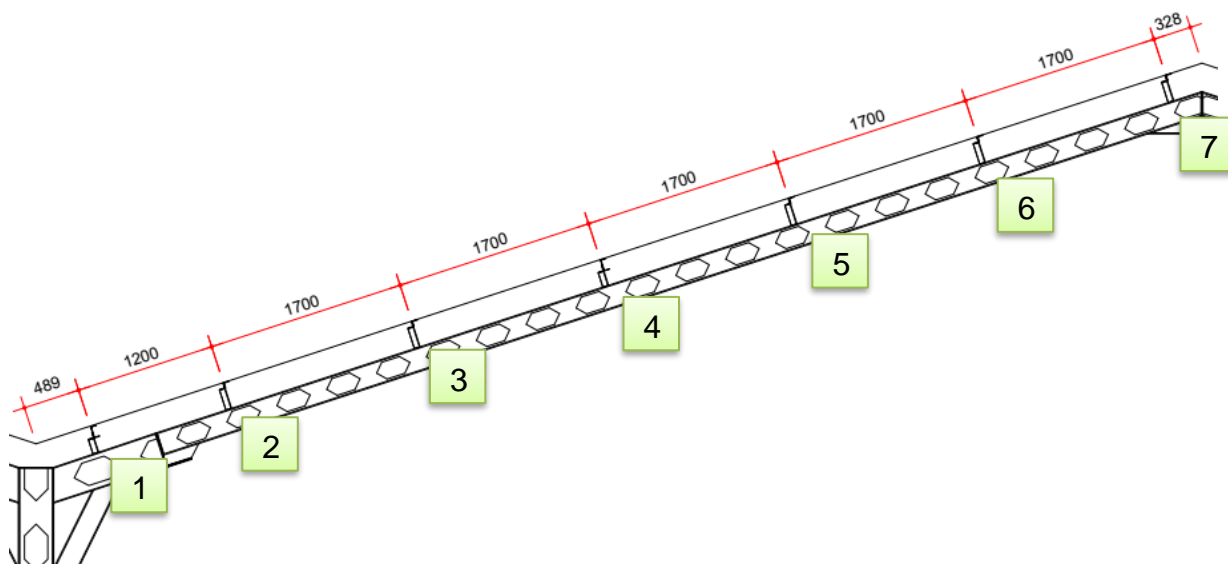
ESPAÇAMENTO DAS TERÇAS (DIMENSÕES EM MM)
